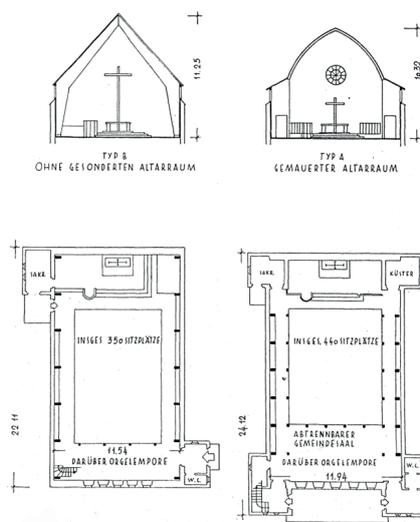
Grundriss, Schnitt Typ B, Typ A
